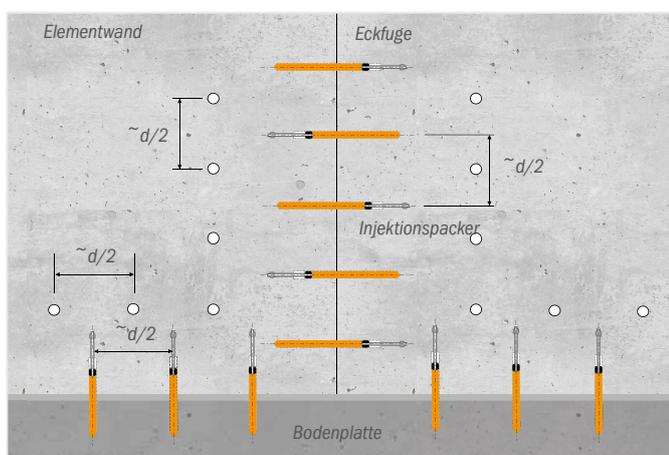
Bohrschema zur Abdichtung einer Elementwanddecke durch Injektion (Beispiel) [7]
